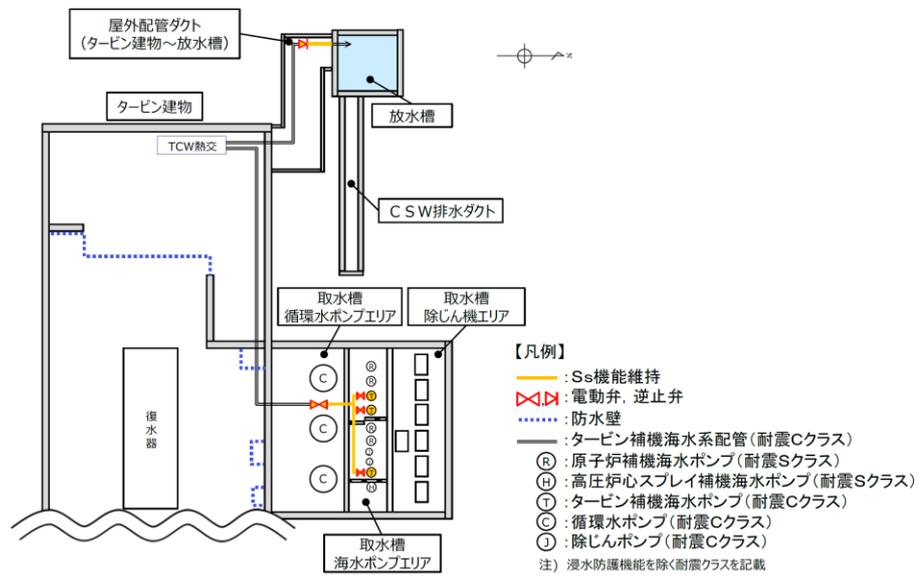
タービン補機海水系の対策概要 (平面図)
